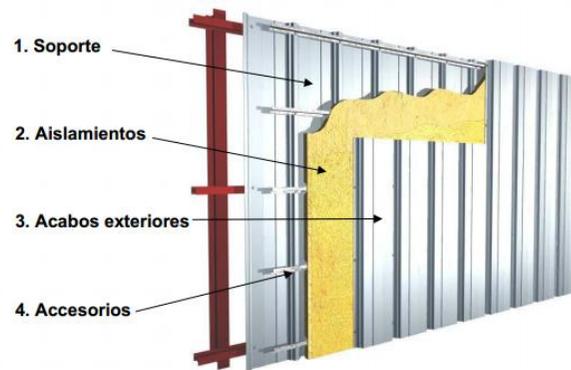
Esquema de elementos de Fachada en aluminio.
